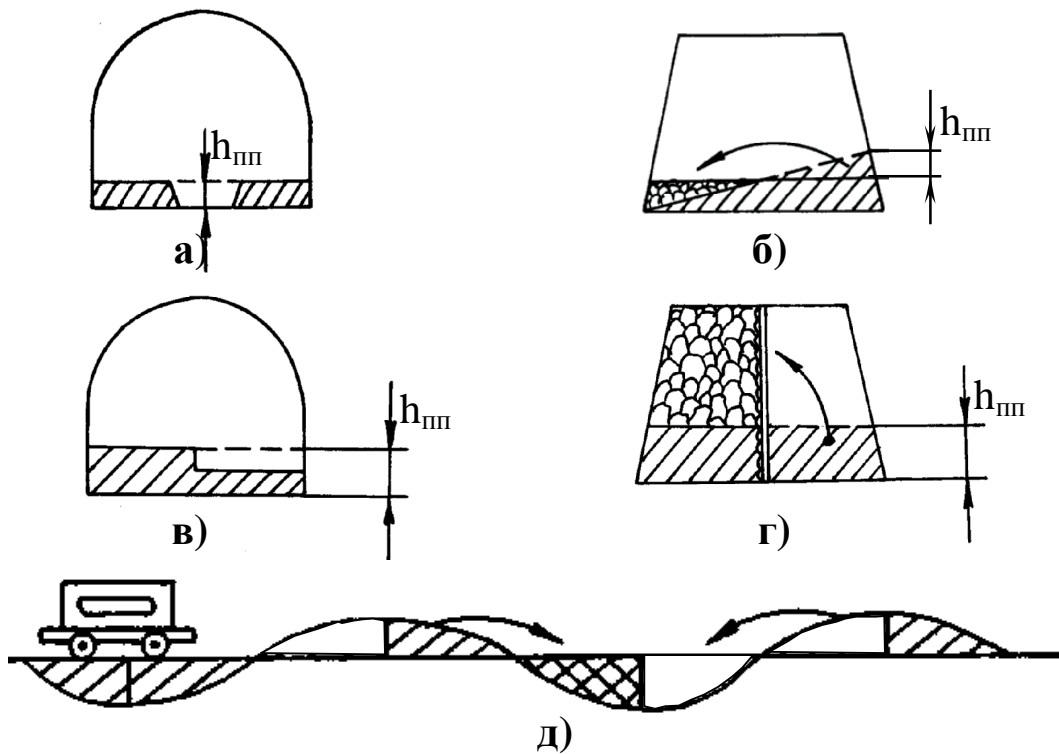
Схемы частичной подрывки пород подошвы выработки: а – по ее ширине; б – с выравниванием поперечного профиля подошвы за счет подсыпки частью отбитых пород; в – по высоте и ширине; г – со складированием пород по бокам выработок; д – по длине выработки после ее подработки с подсыпкой образованных впадин
